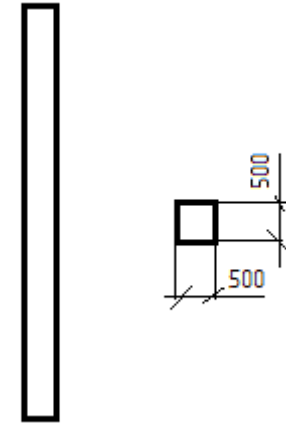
Определение осадок свайного фундамента под среднюю колонну
